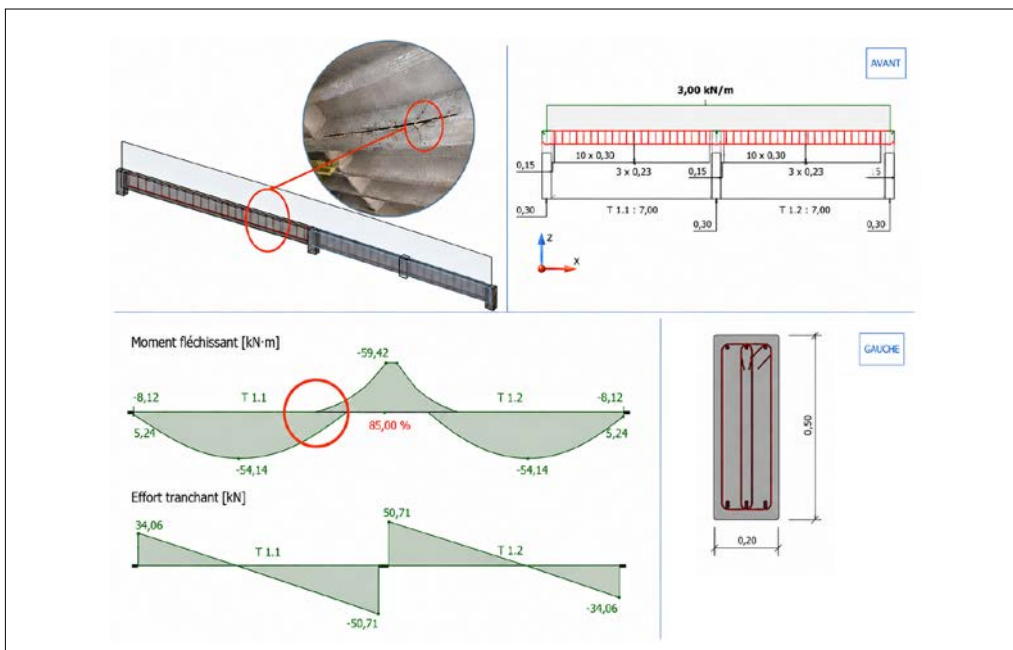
/2 : Exemple d'une redistribution des sollicitations dans le cas d'une corrosion d'armature de poutre continue
